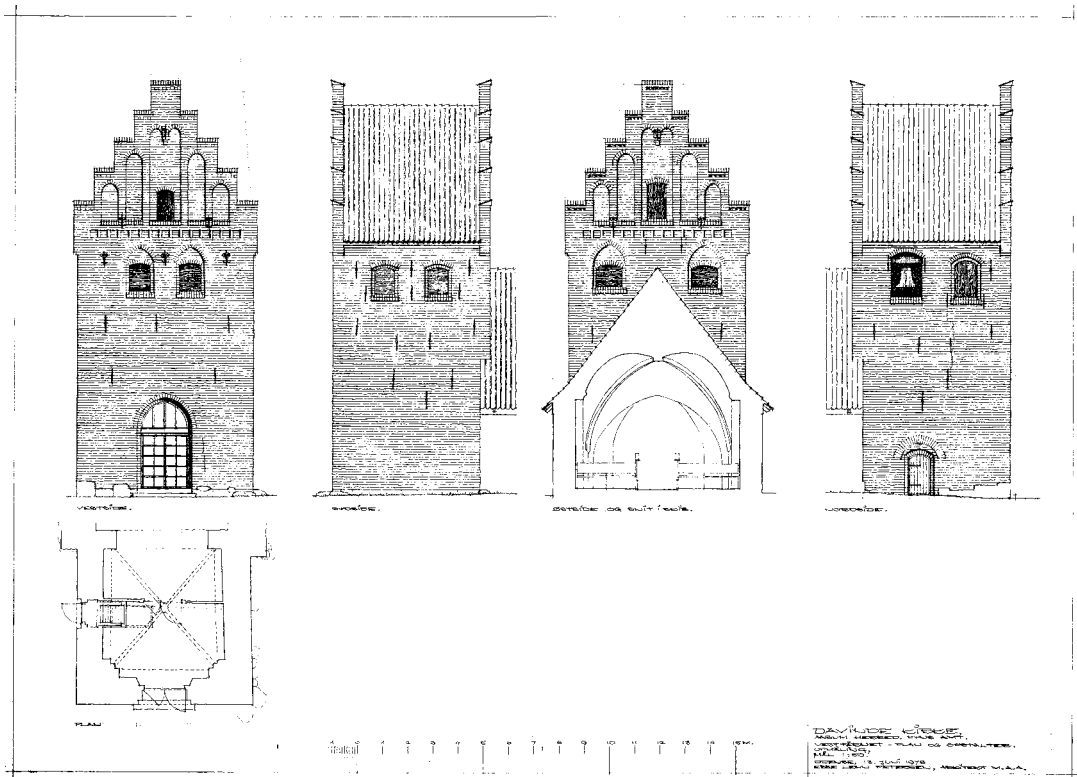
Tårnet. 1:300. Plan og opstalter. Målt og tegnet af Ebbe Lehn Petersen 1978. – *The tower. Plan and facades.
